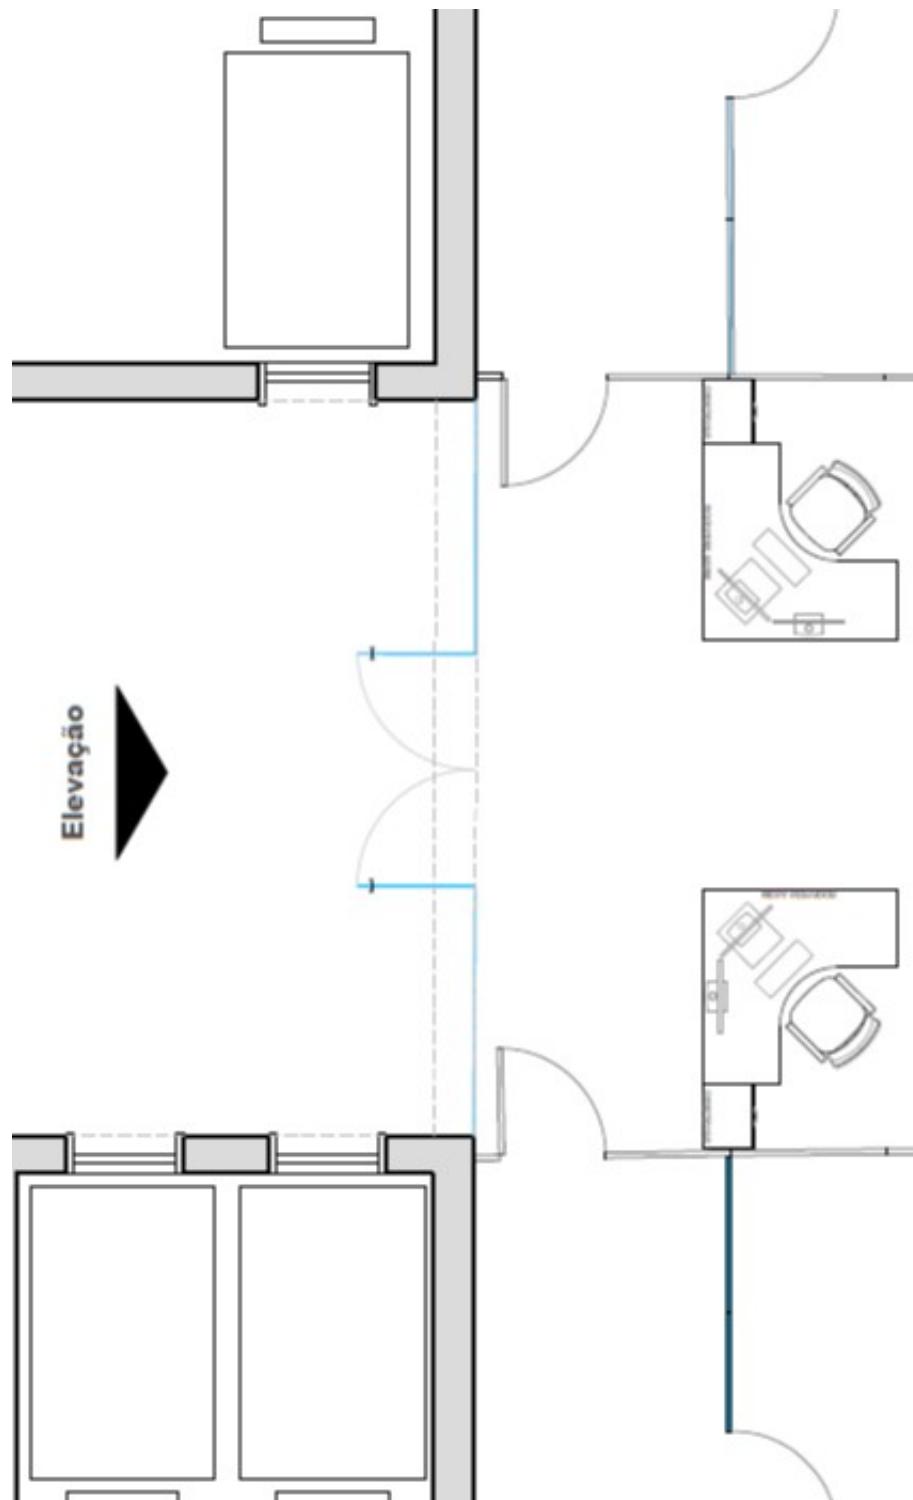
Planta Baixa demonstrando alinhamento da divisória em relação à viga superior e sentido de abertura das portas.
